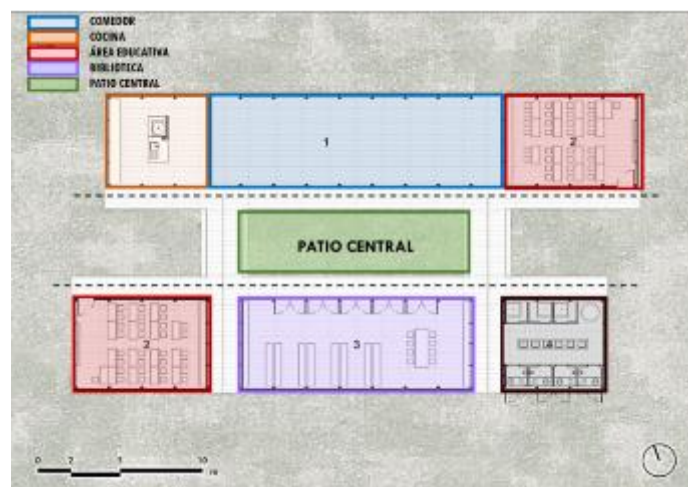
Planta arquitectónica Centro Educativo. Fuente: Archivo Construye Identidad.
